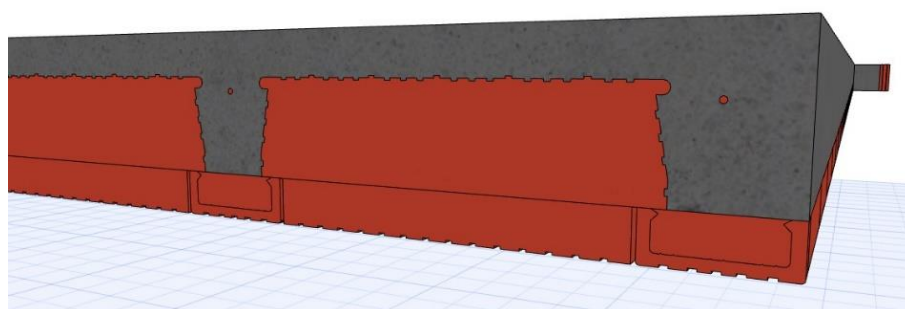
Objekty Heluz bez děrování – 3D řez stropní konstrukcí
